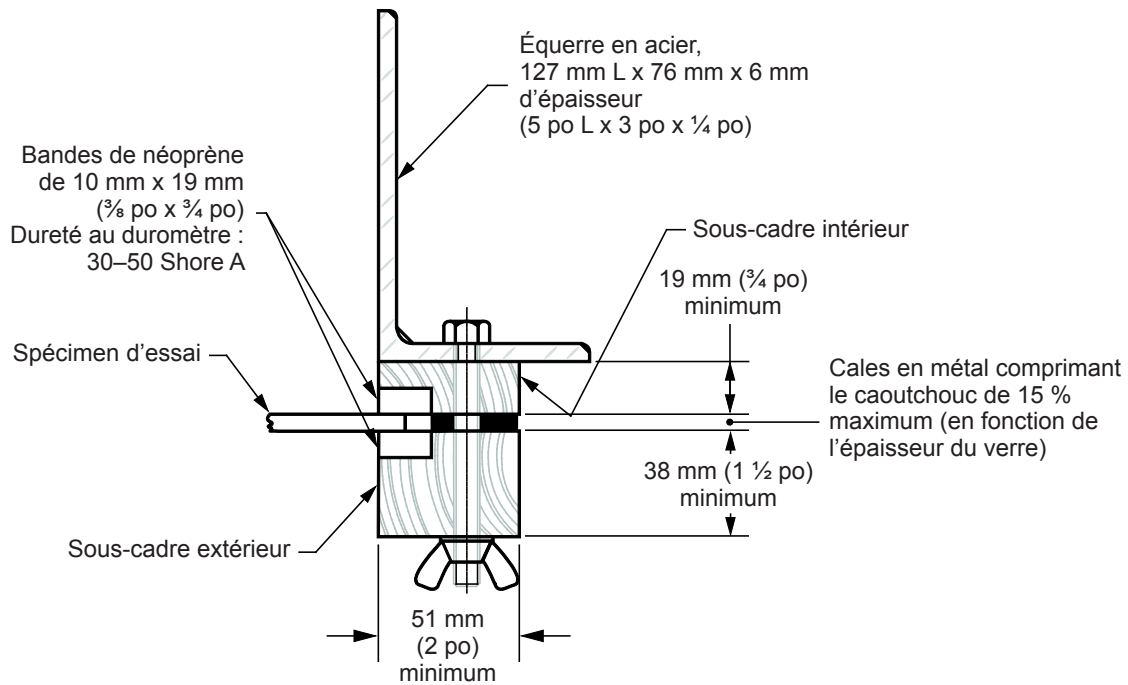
Détail de la coupe A-A — Spécimen d'essai correctement fixé (> 3mm [1/8 po])
